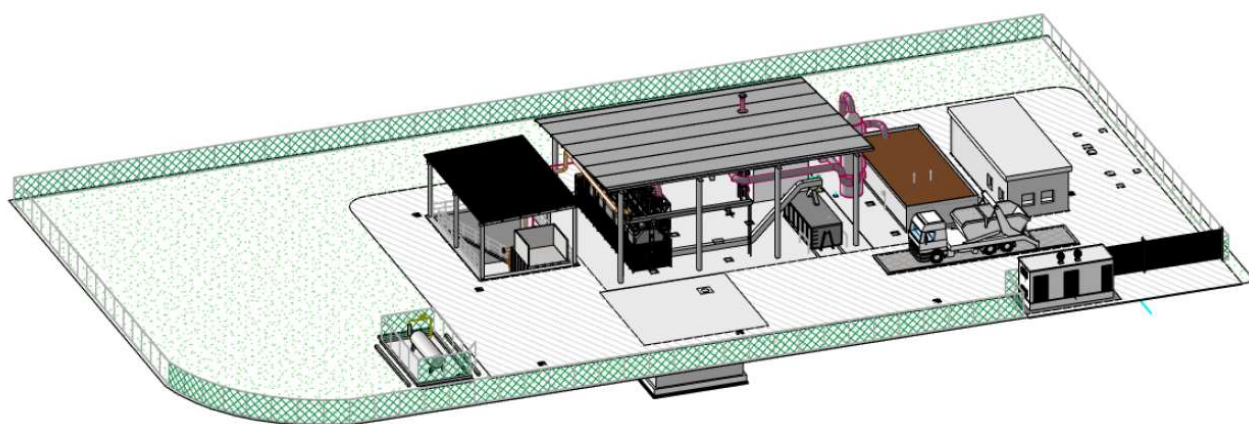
Vista 3D dell'ingresso impianto con indicazione della zona pesatura e dell'ufficio accettazione
